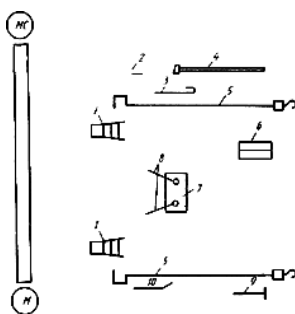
Схема организации рабочего места при монтаже цокольных панелей стен
